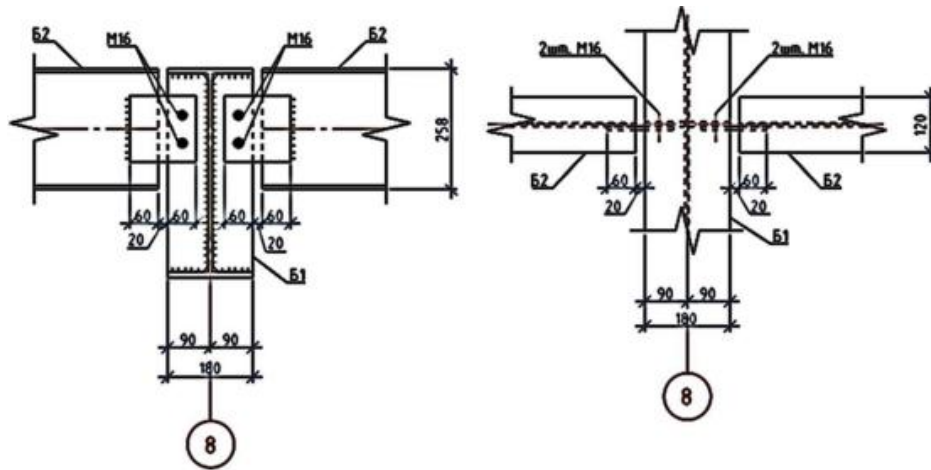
З'єднання другорядної балки з головною балкою
